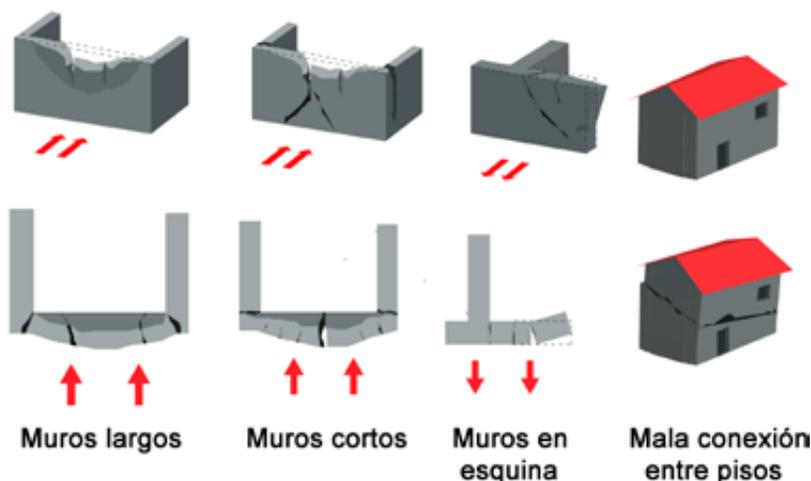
Tipos de grietas según el esquema estructural
